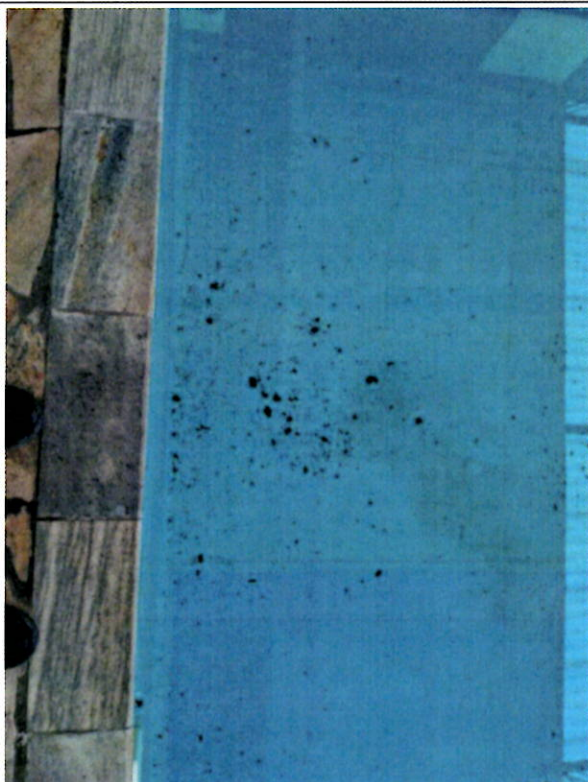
Ponto de ferrugem que caíram a piscina expondo a fragilidade da estrutura metálica de cobertura
